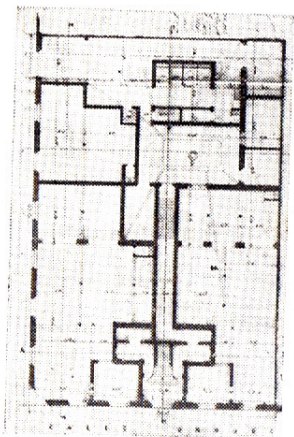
Casa de Félix Buxareo — Planta baja.
